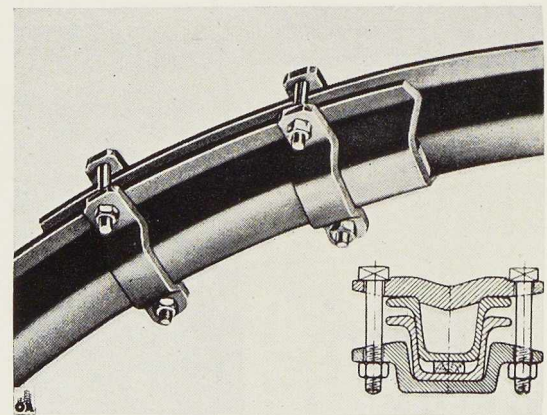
Assemblage coulissant du soutènement de mines T.H.; la forme en auge des profilés est à noter.
